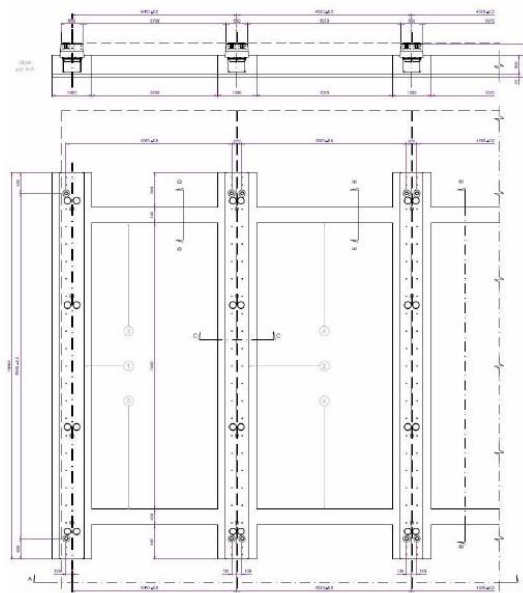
Vista general de una cimentación resuelta con la viga de cimentación del sistema Compact Habit®
